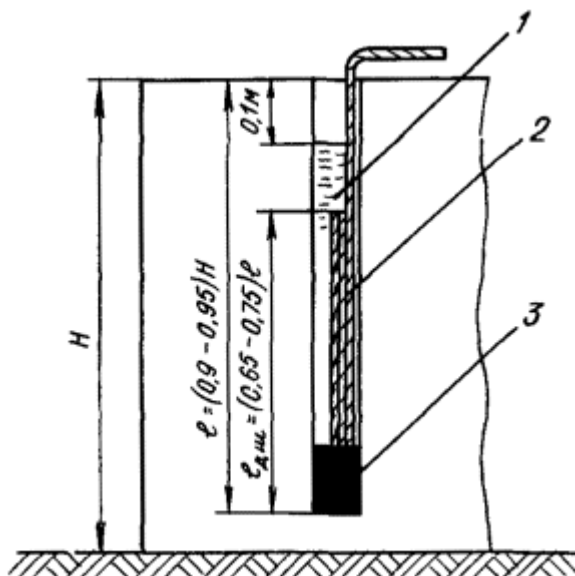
Конструкция заряда при гидровзрывном способе разрушения фундаментов:
